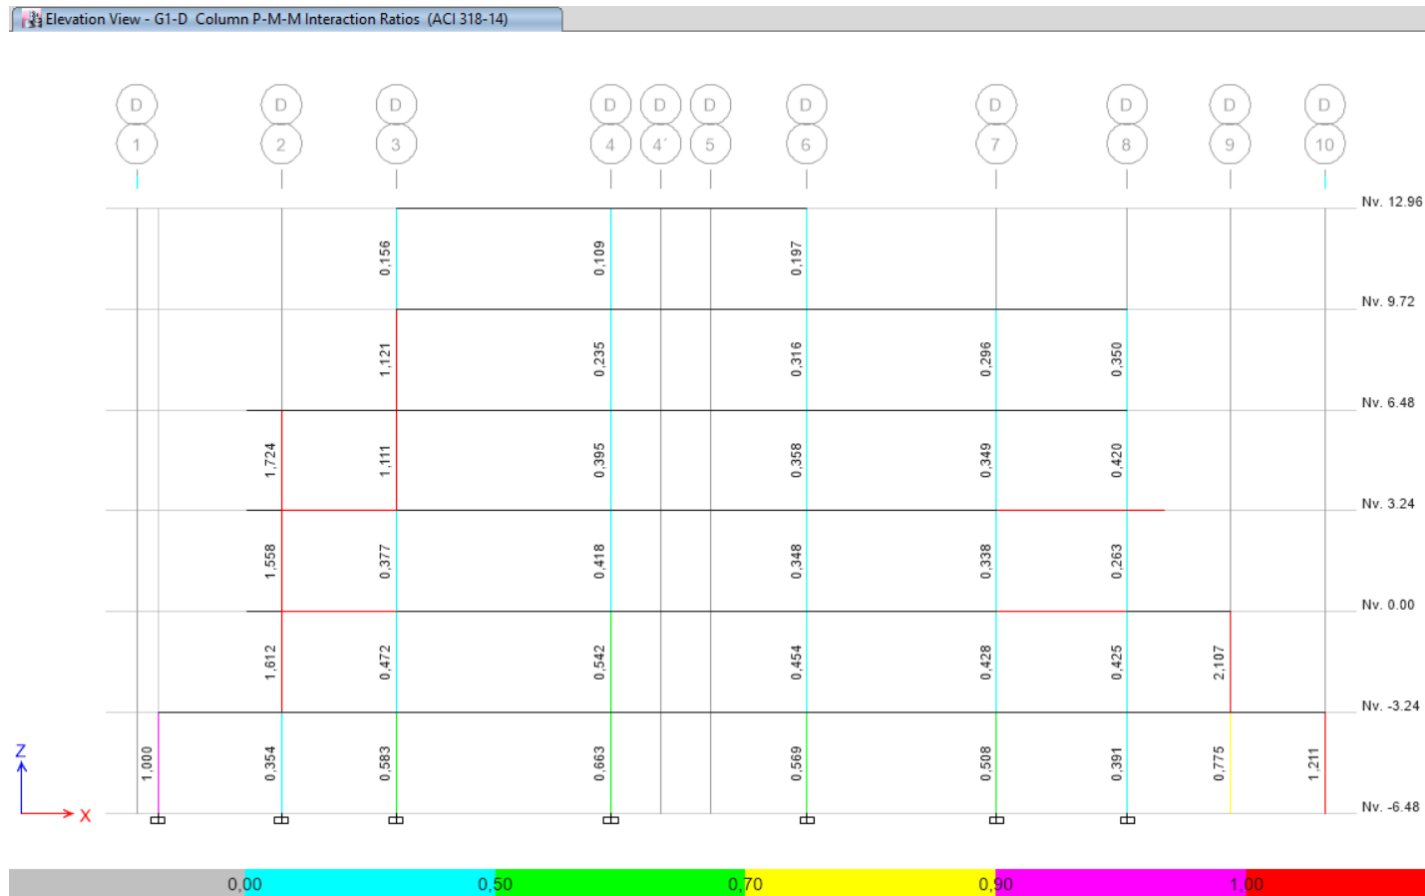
Vista en elevación de la demanda/capacidad en columnas, pórtico eje C.
